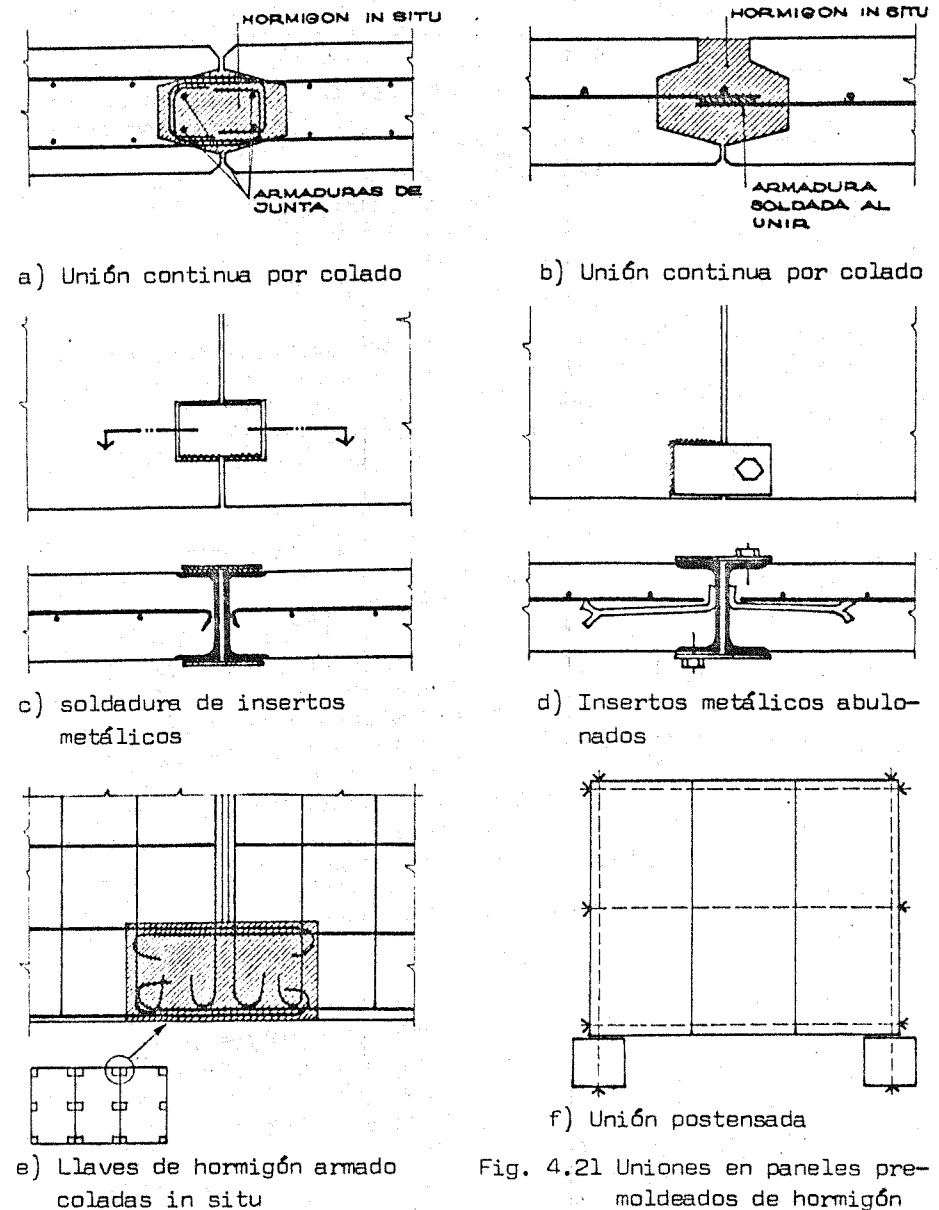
Uniones en paneles pre-moldeados de hormigón armado
